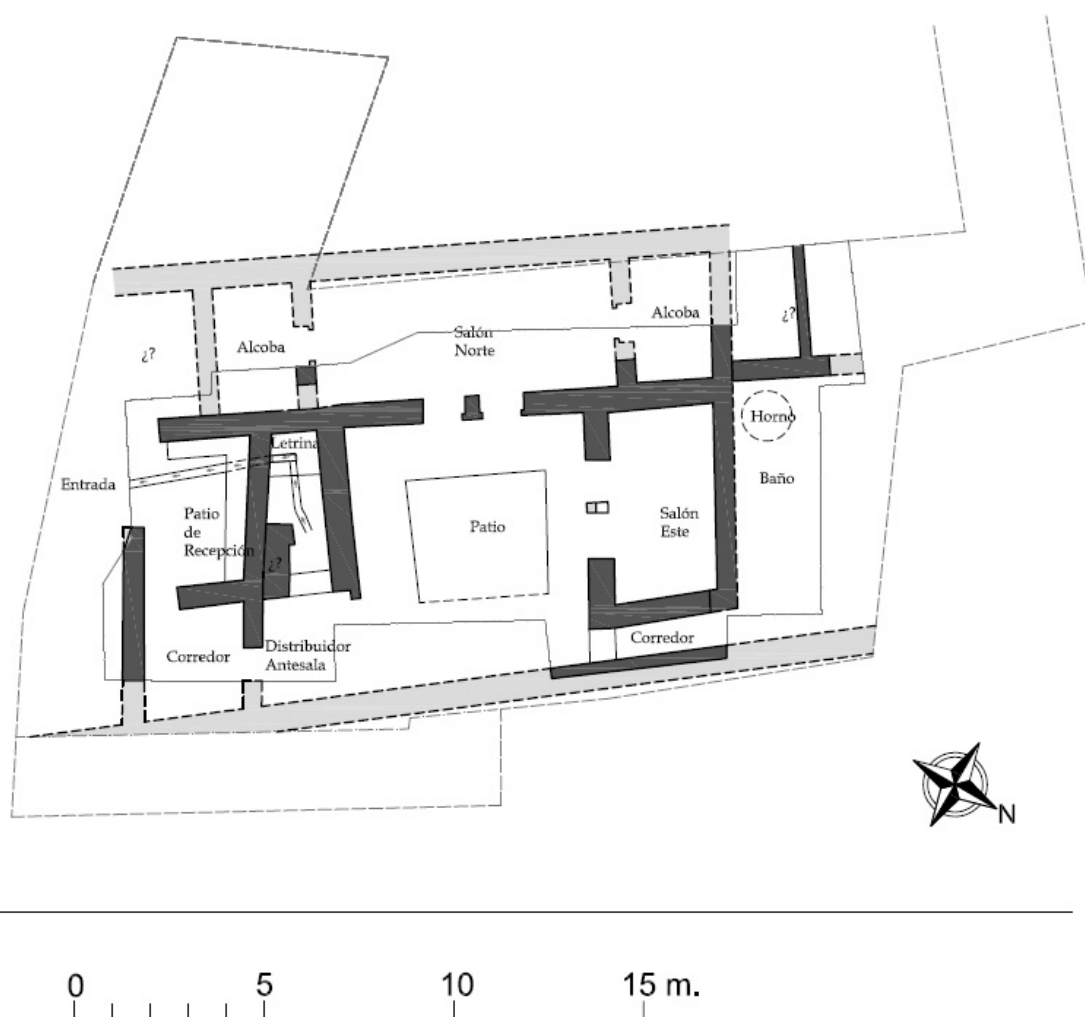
Casa y baño de calle Pascual. Croquis de la planta
